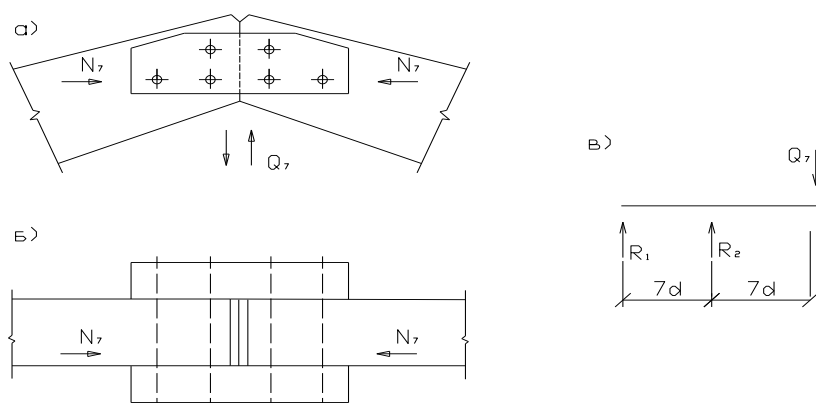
Схема крепления конькового узла: а) вид сбоку, б) вид сверху, в) схема левой стороны накладки для расчета болтов
